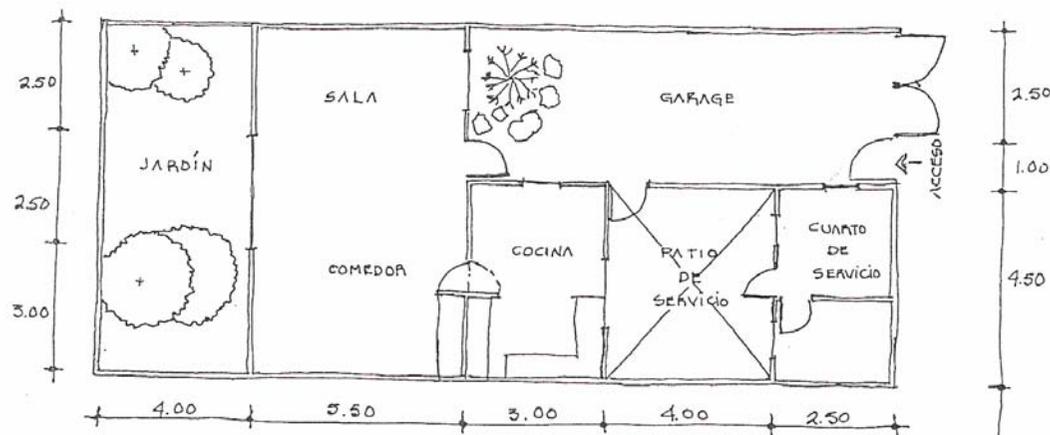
Croquis de una planta arquitectónica a mano alzada
